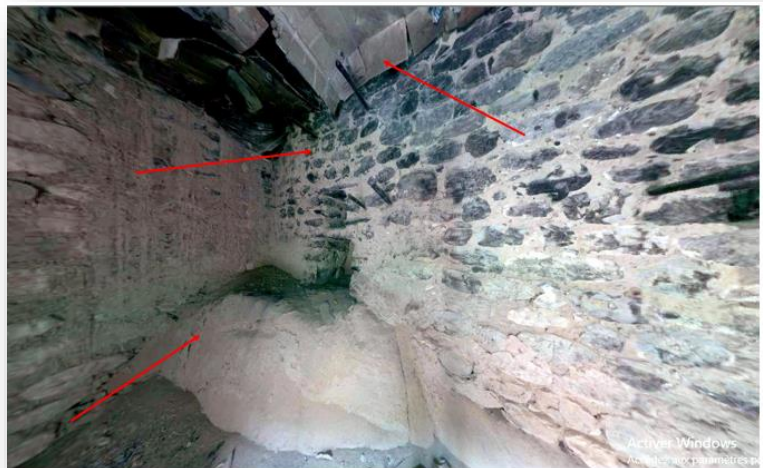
La maison 10 est construite sur le mur de soutènement du ksar. Source : Auteure.2022
